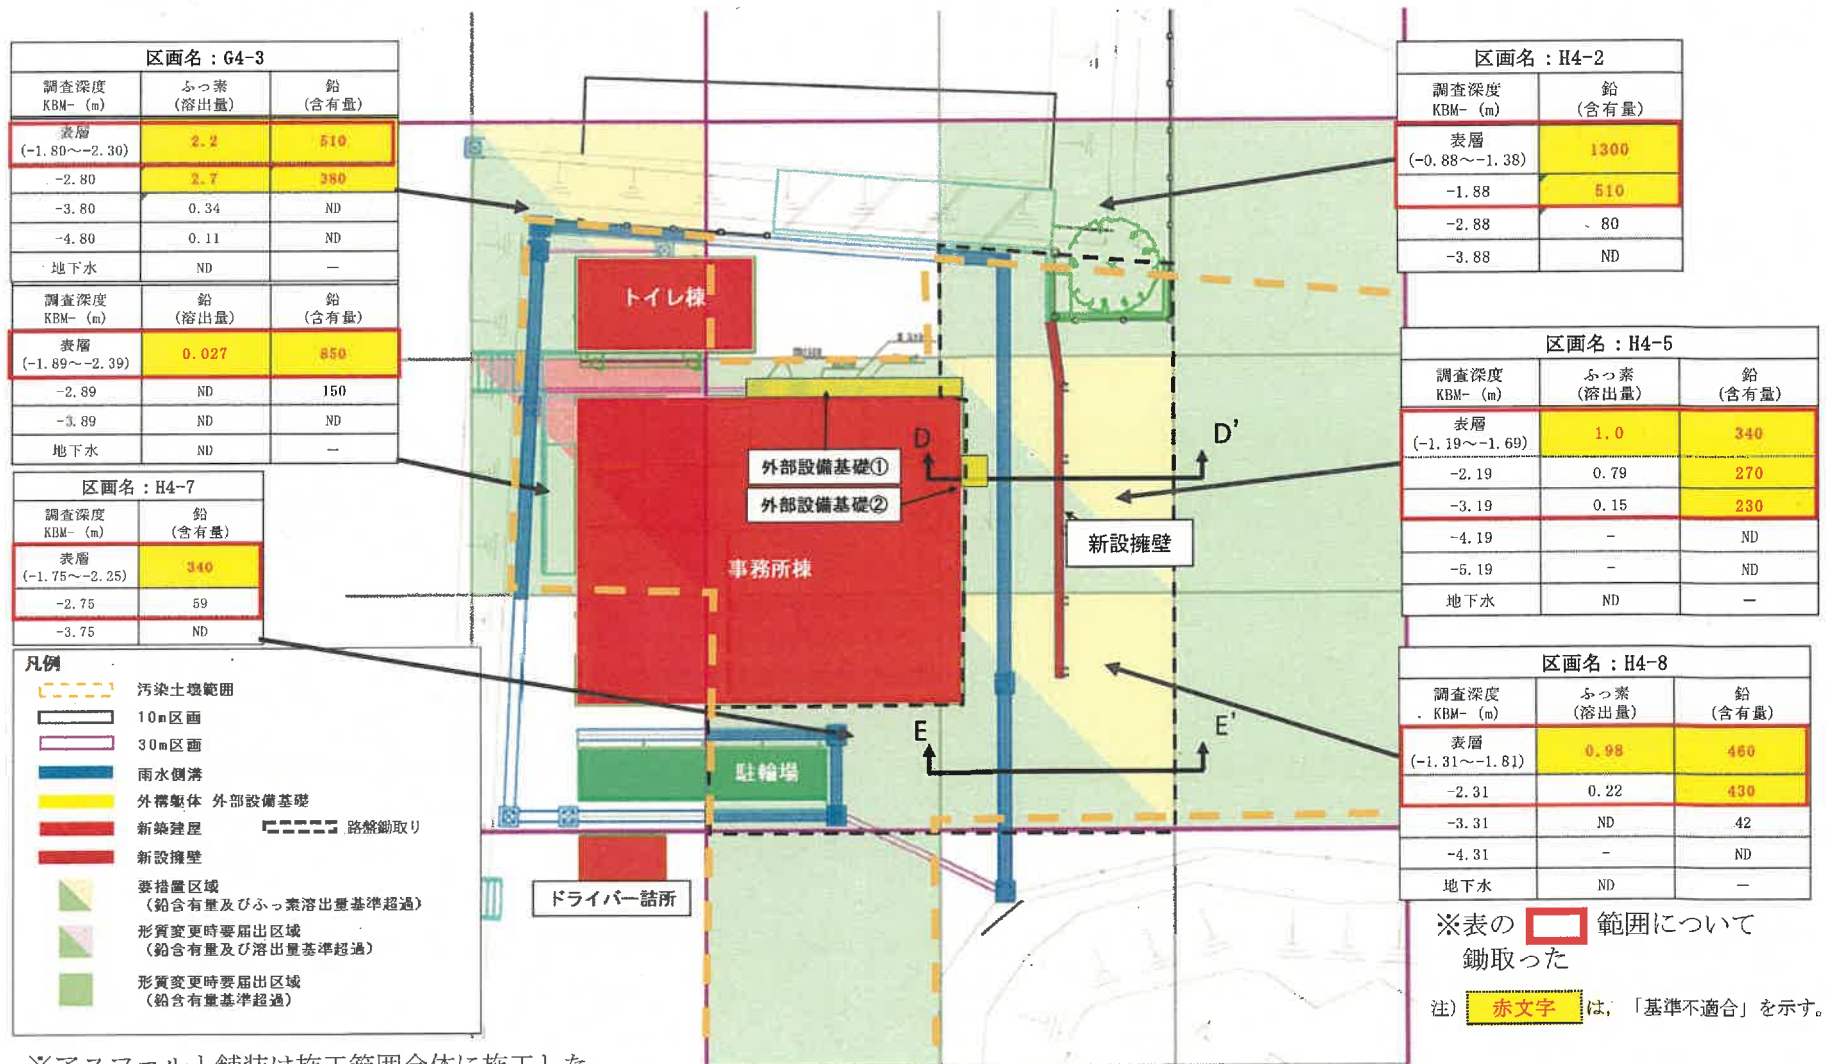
土地の形質の変更の施工方法を明らかにした平面図（雨水排水工事，路盤鋤取り，アスファルト舗装工事）
